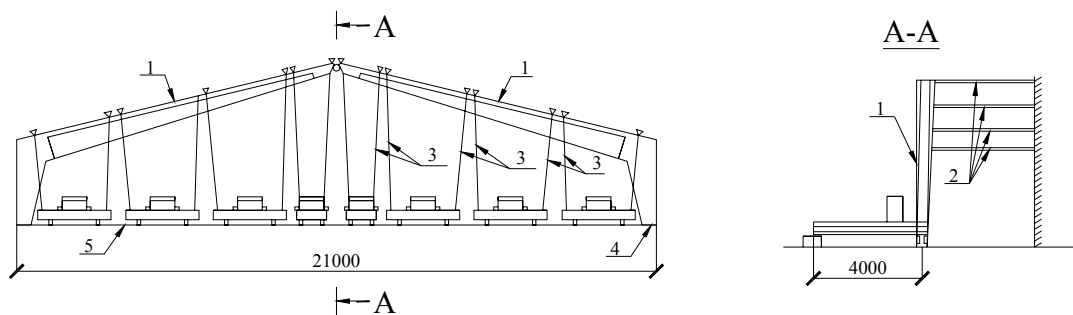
Схема стенду для досліджень рамних каркасів:
